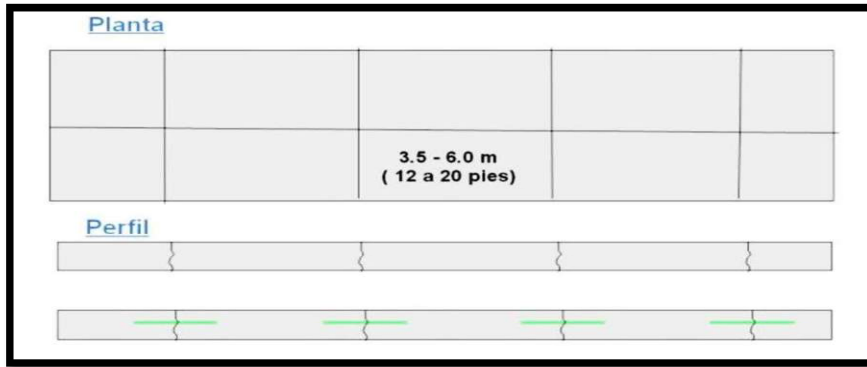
Elementos De Un Pavimento Rígido Con Juntas
